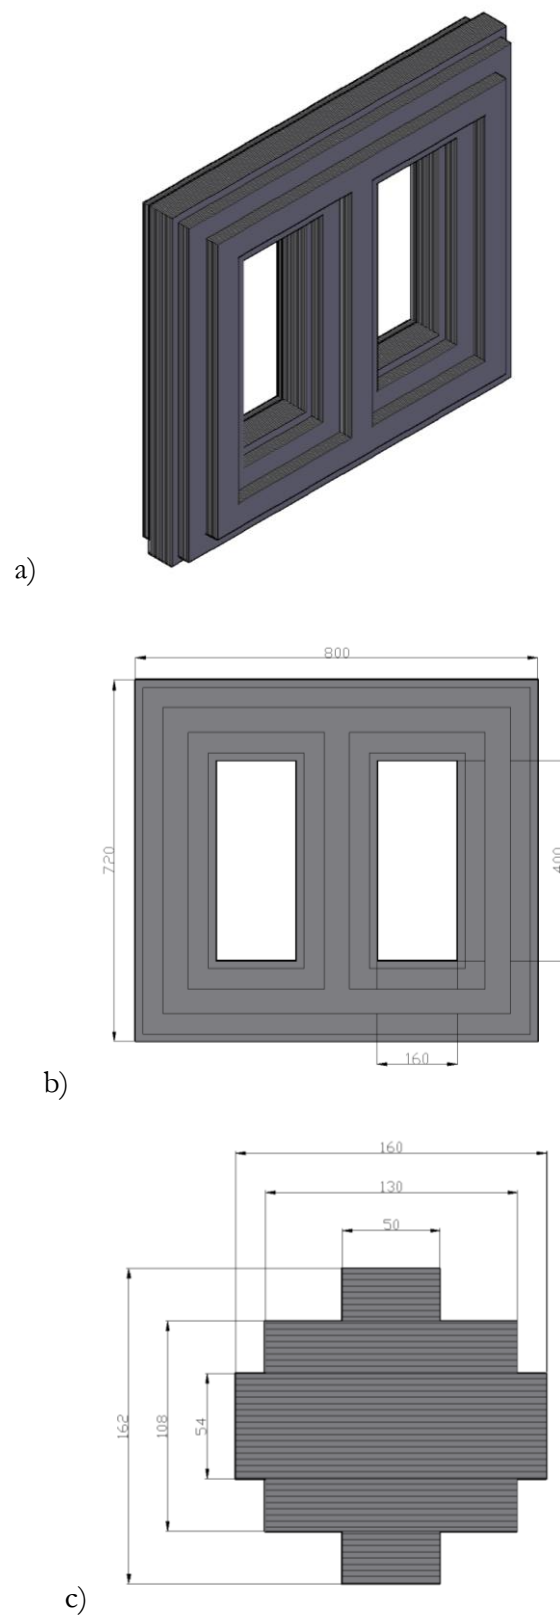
Dimensions des core models a) vue de profil, b) vue de face, c) coupe d'une colonne
